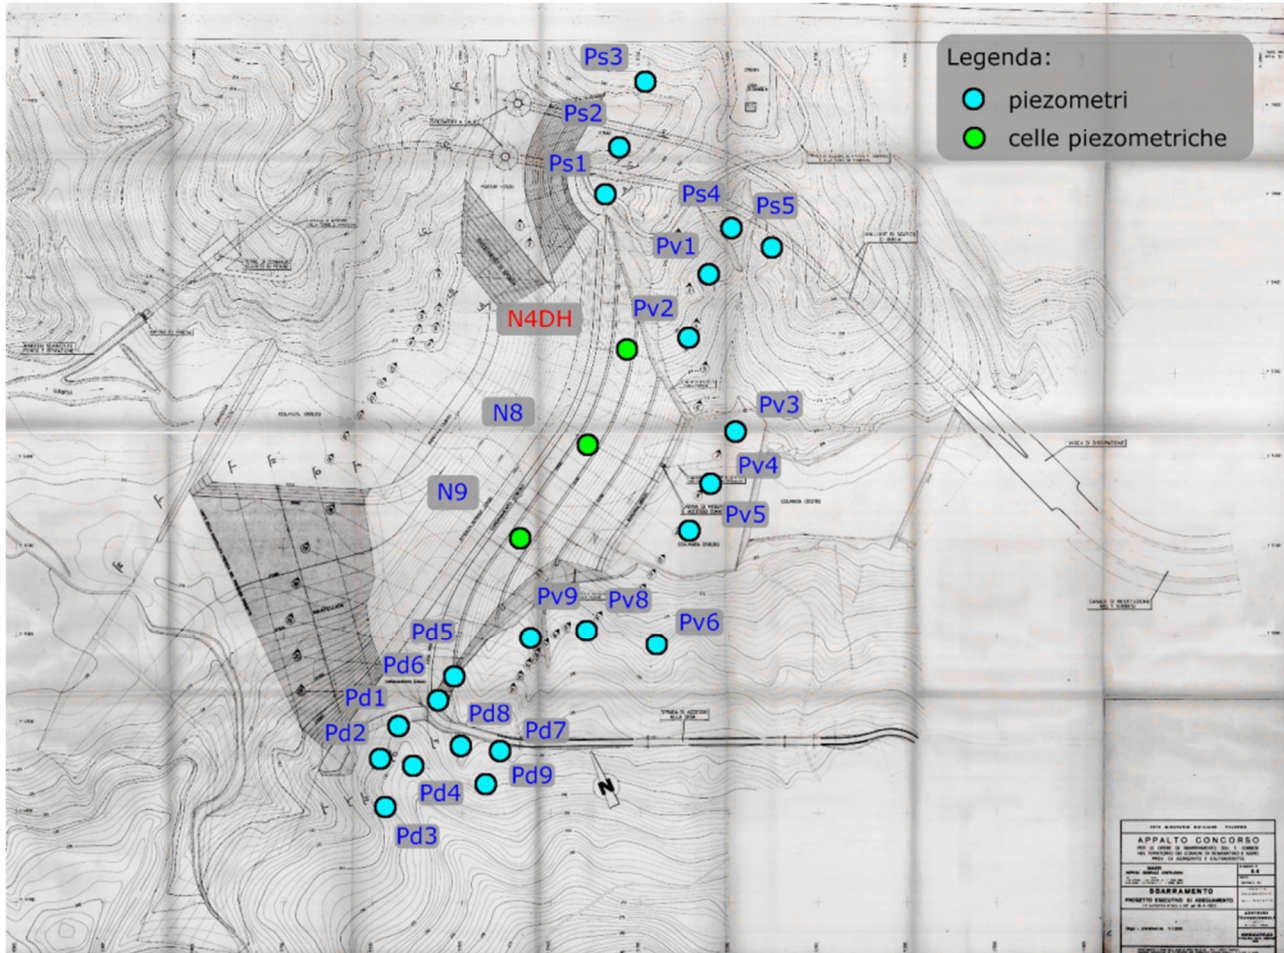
Vista planimetrica della diga con indicazione dei piezometri.
